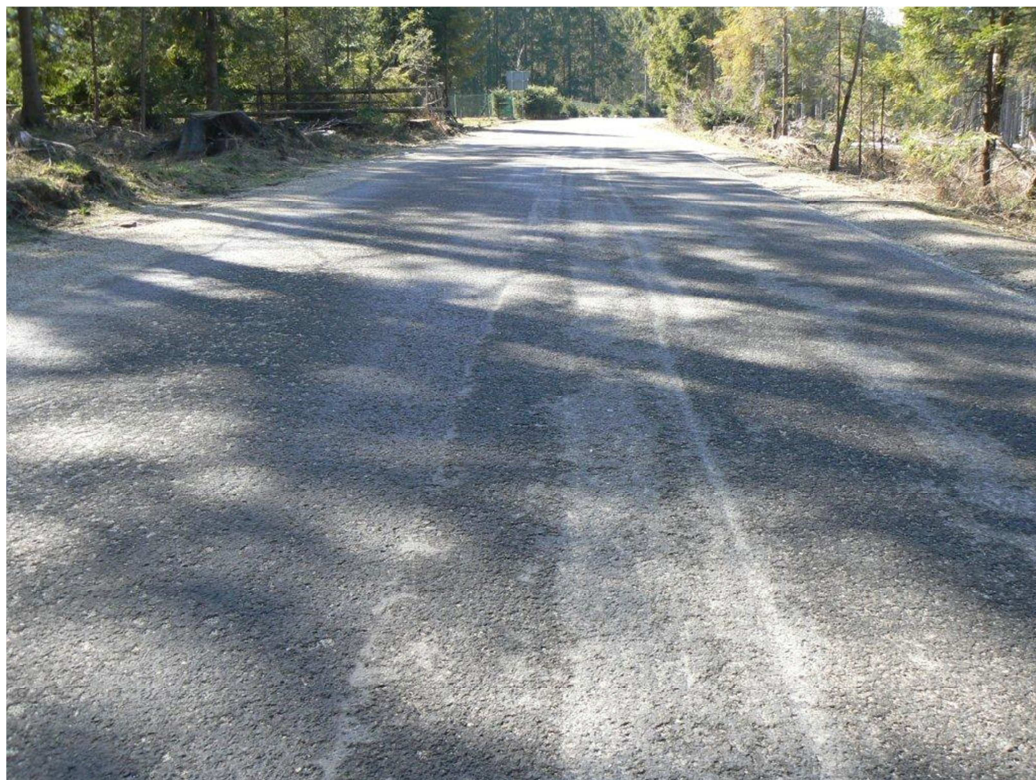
Problémové místo - příčný odvodňovací žlab [38]
